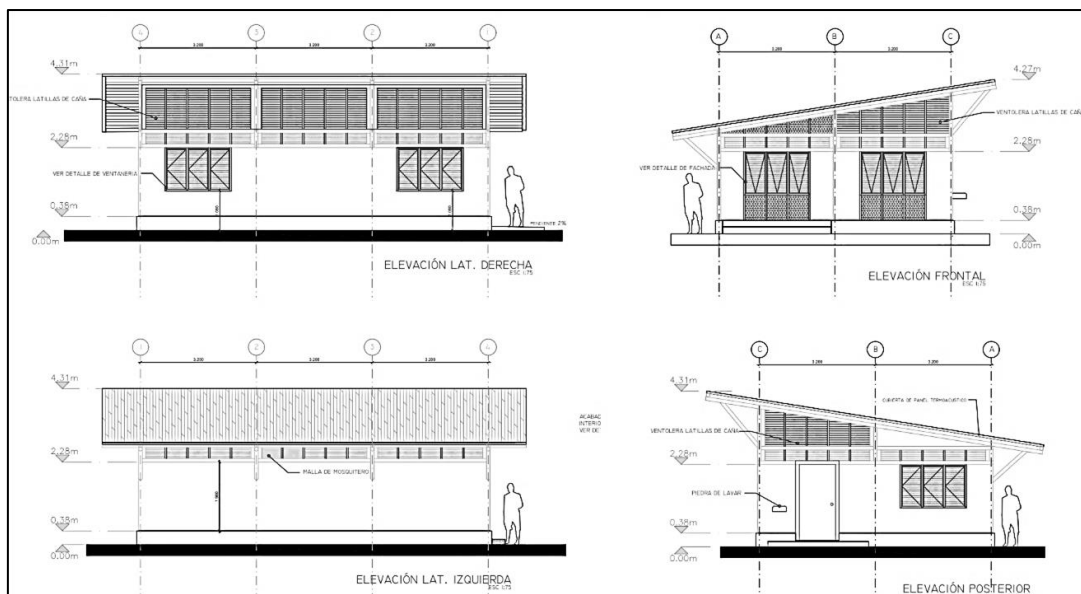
Elevaciones/Fachadas de vivienda en caña guadua Fuente: (MIDUVI, 2023)
